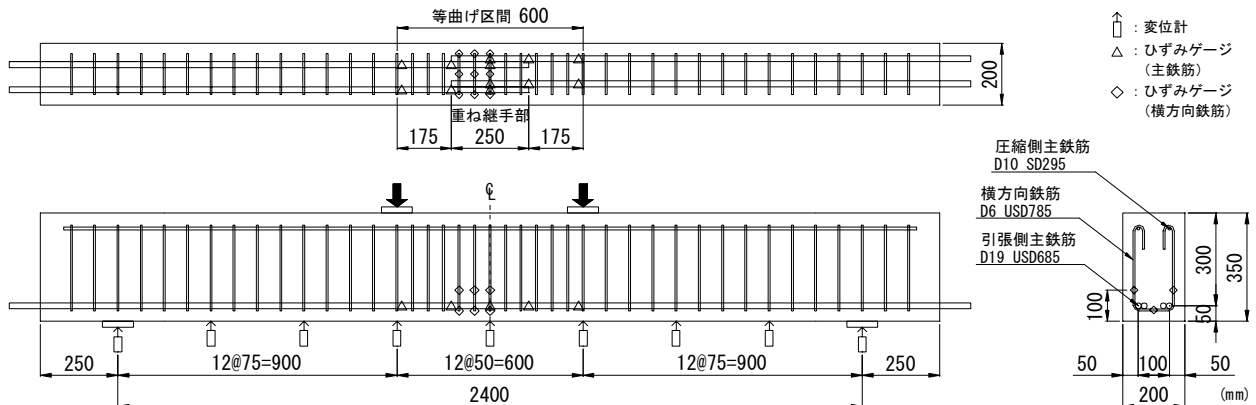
定着長確認試験体の形状寸法 (LAP250-S 試験体)
